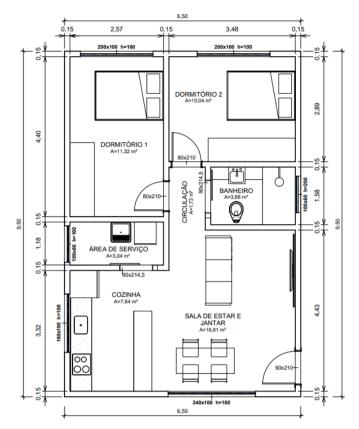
Planta Baixa Casa Alvenaria Convencional
